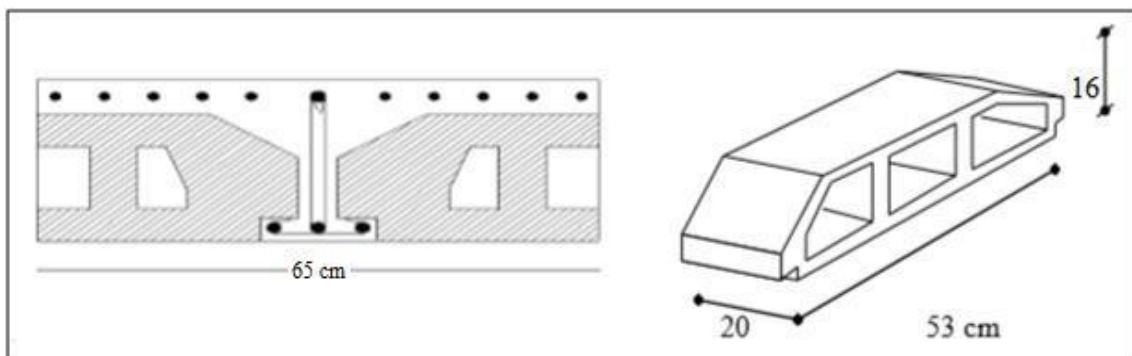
Coupe du plancher en corps creux et dimension de corps creux
